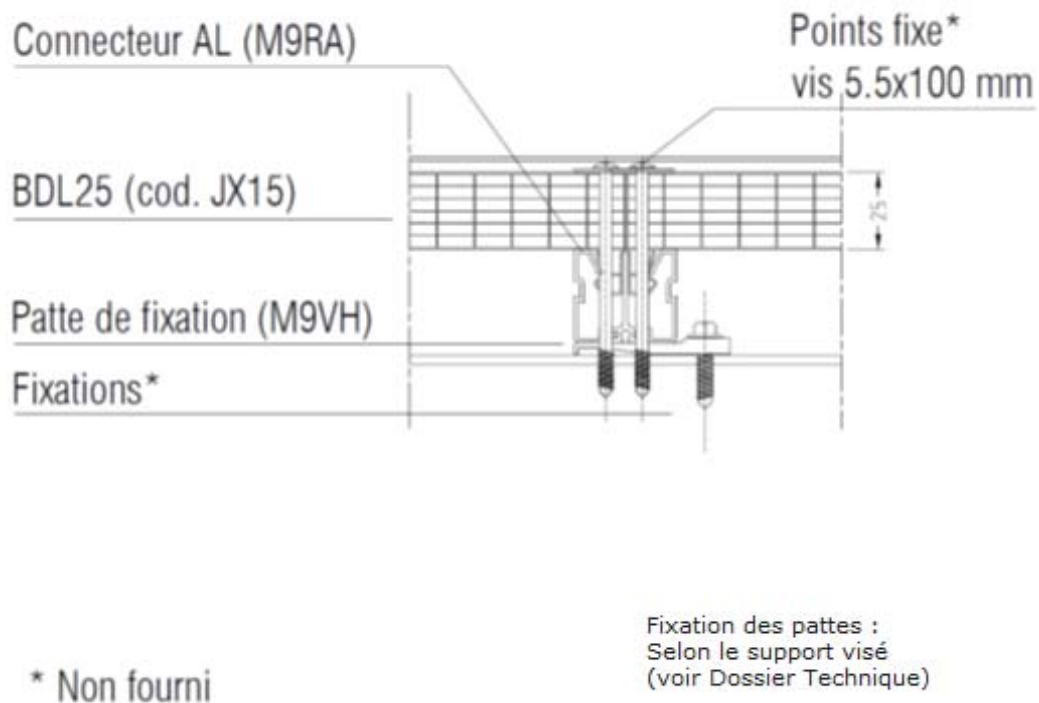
Position en section point fixe - Pose avec point fixe haut
